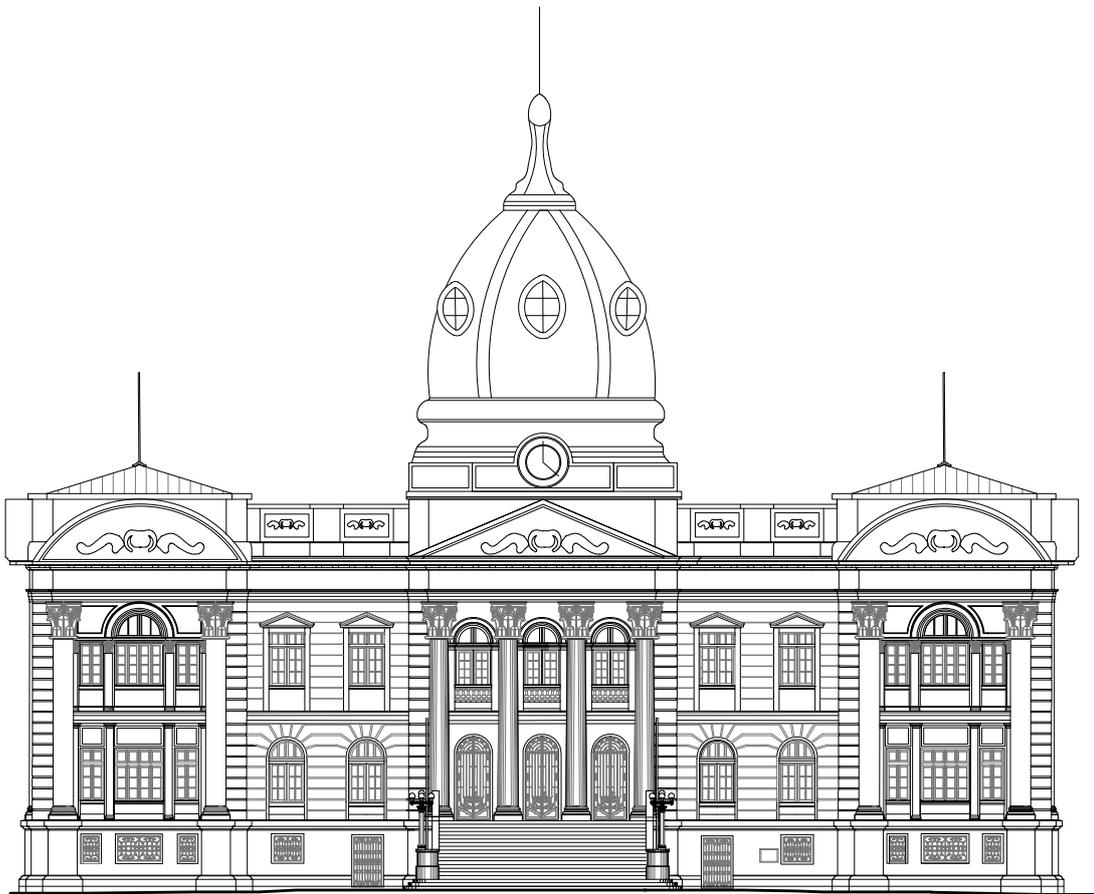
Redesenho da fachada principal da Secretaria da Fazenda. Projeto de Barros.
